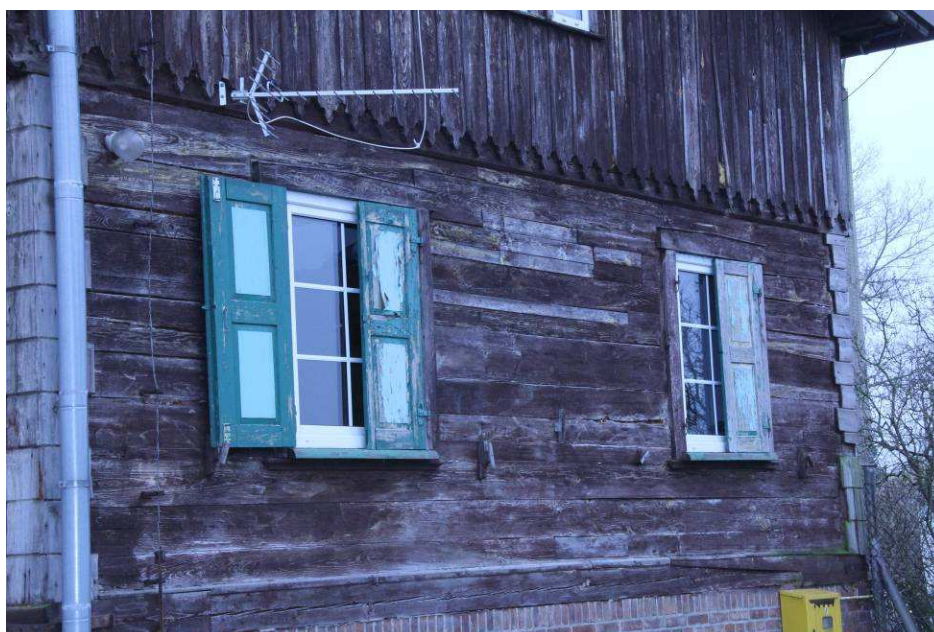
Elewacja wschodnia, deskowanie górnej kondygnacji.
